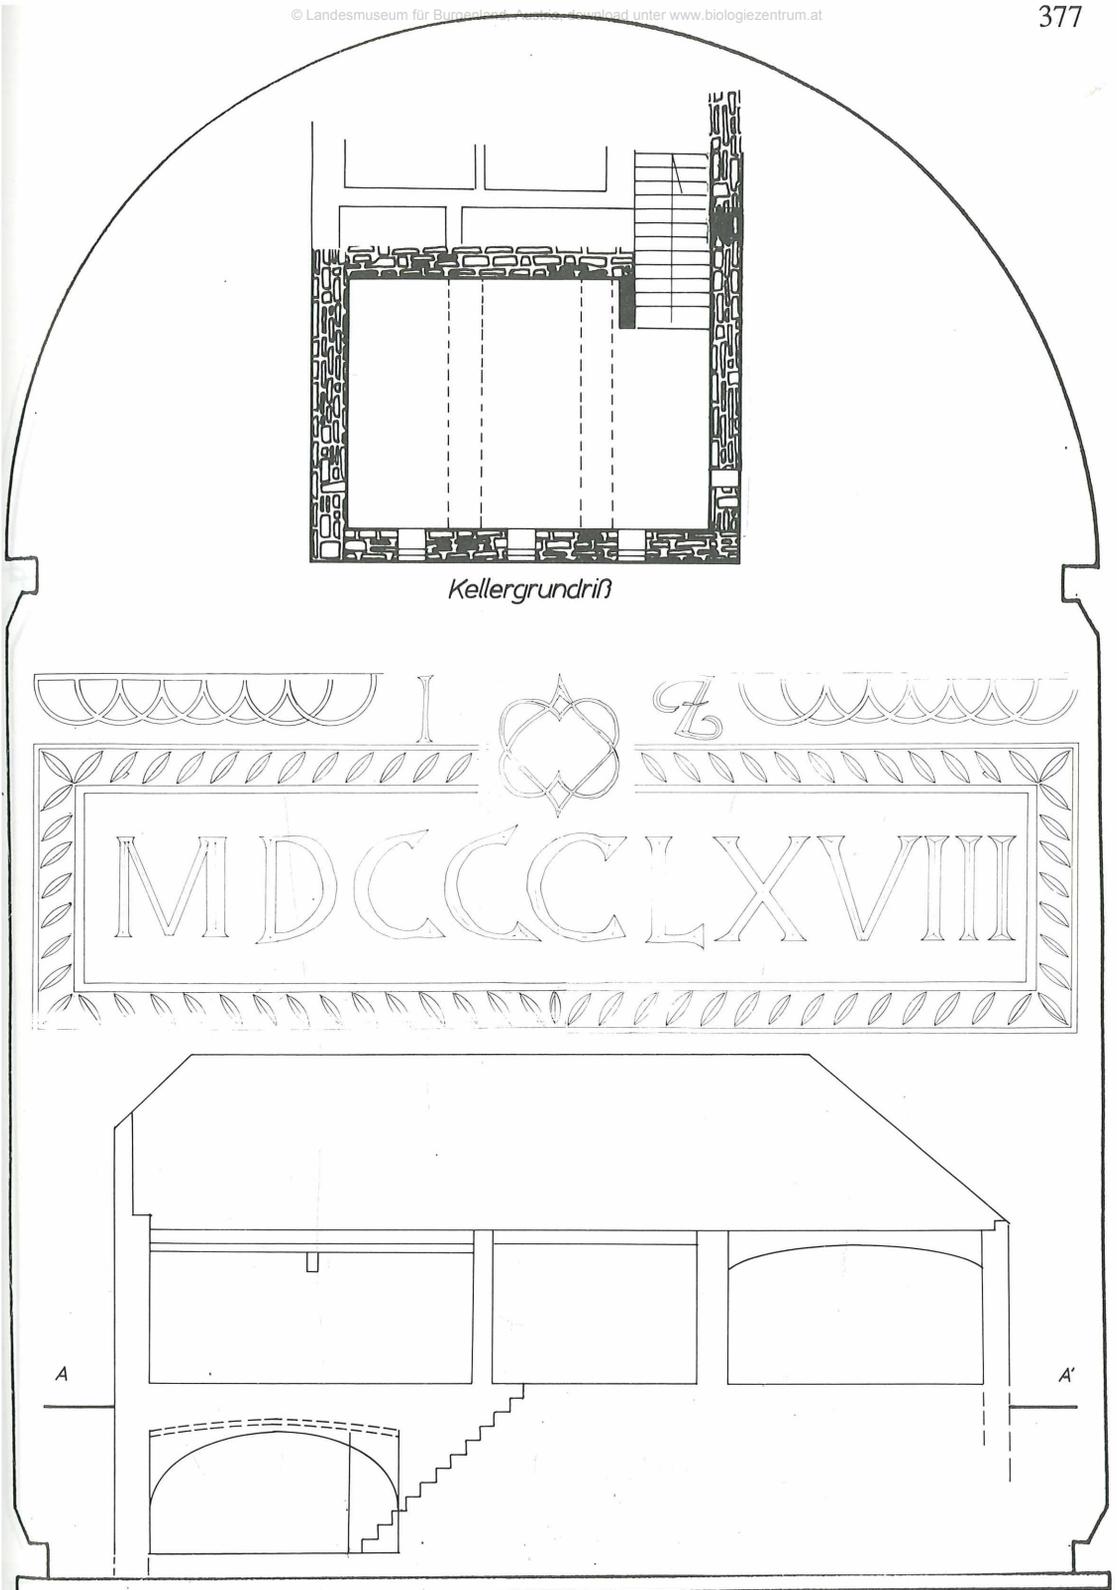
Aschau Nr. 46 - Schnitte, Details und Lageplan
